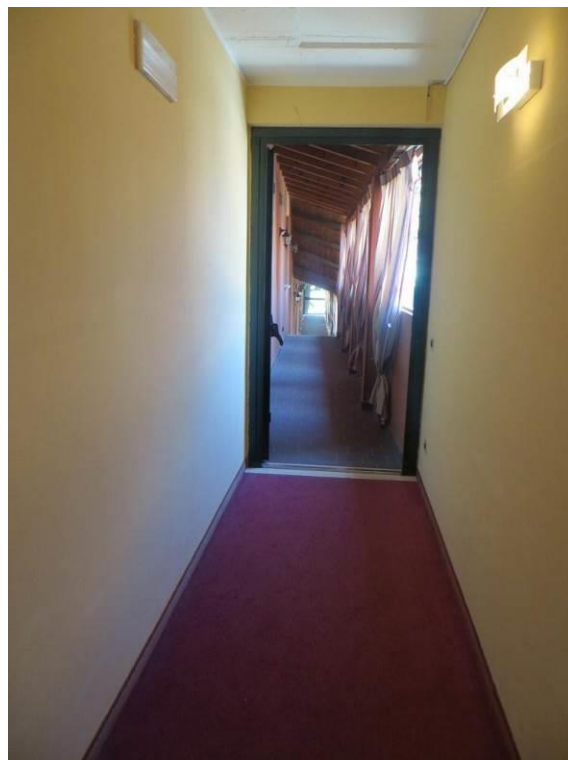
/72 – Corridoio di accesso alle camere al piano primo
